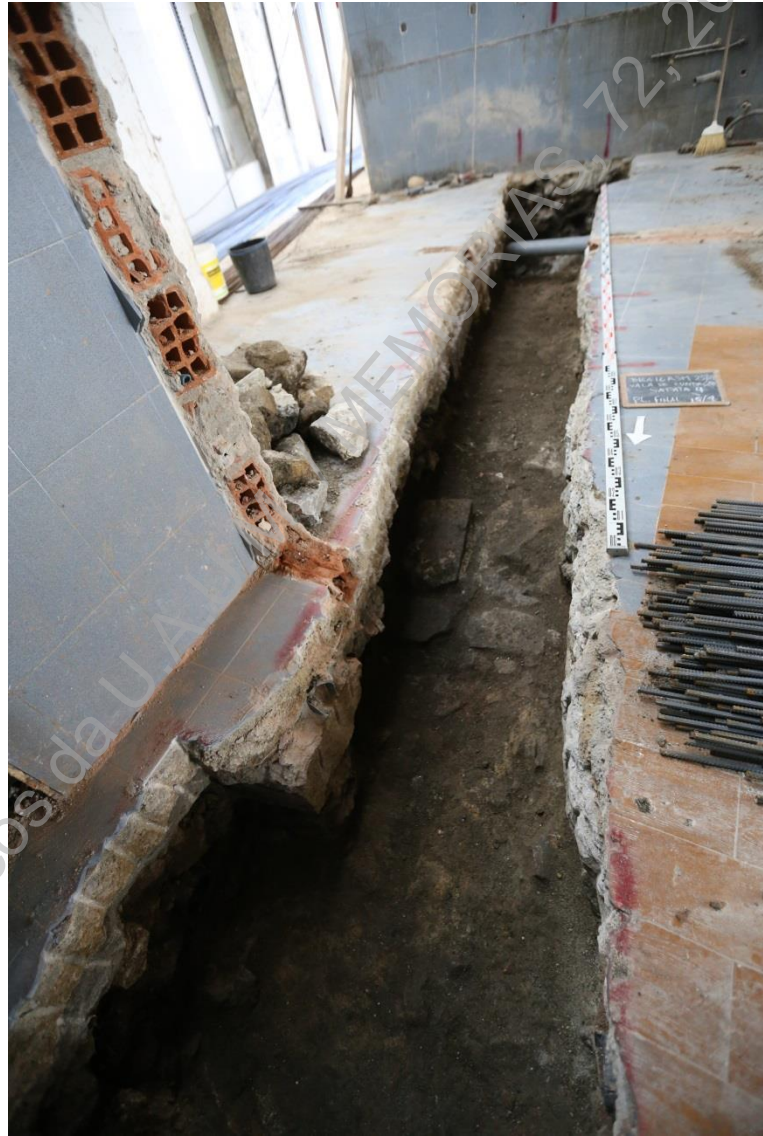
(IMG_1795) – Aspeto final da escavação da vala para implantação da sapata 3 (N/S).
